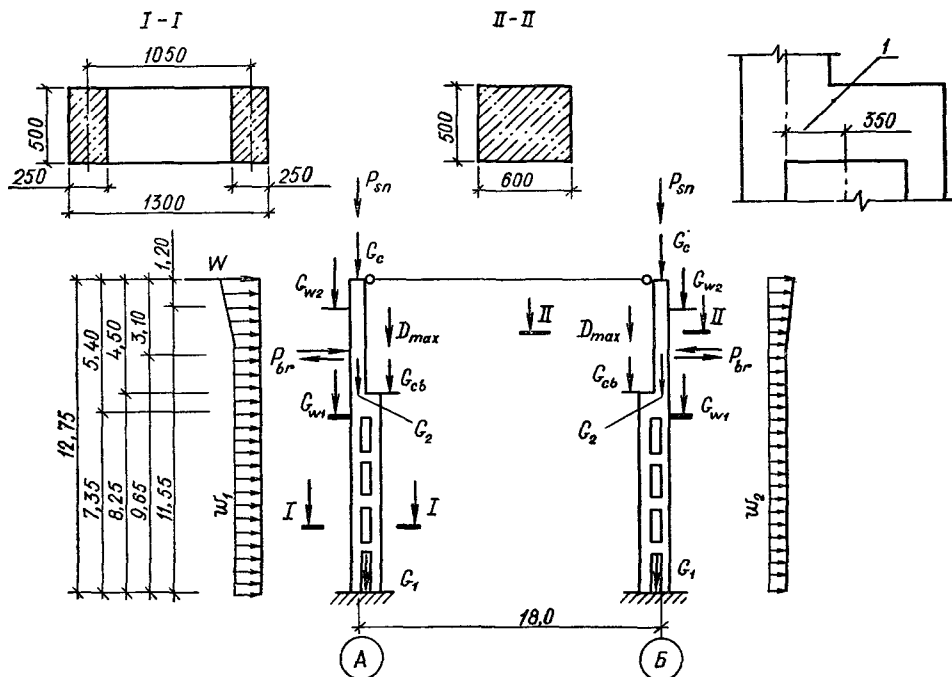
Расчетная схема поперечной рамы и схема нагрузок:
